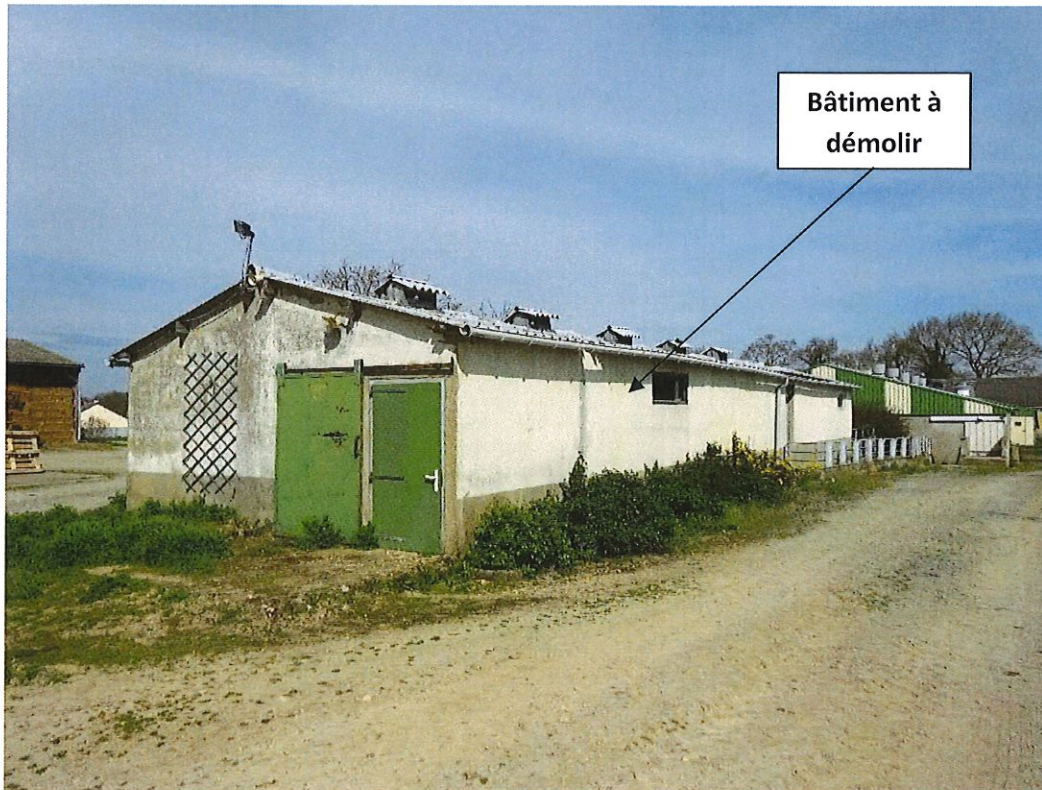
Vue éloignée du site de la salle LA CHAPELLE THOUARAUULT – Côté Ouest
